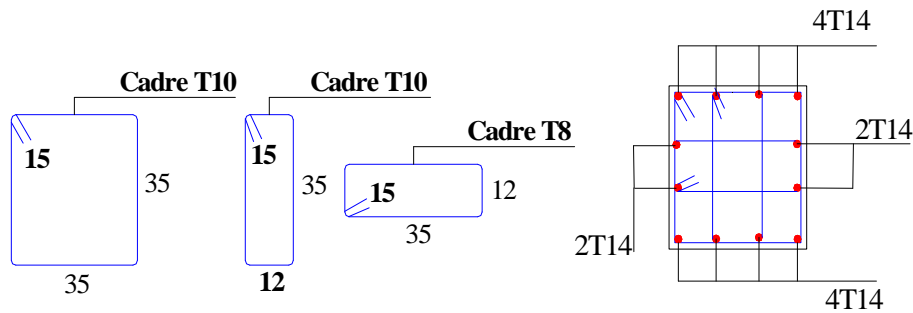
Schéma de ferrailage des poteaux étage 09, 10 et 11
